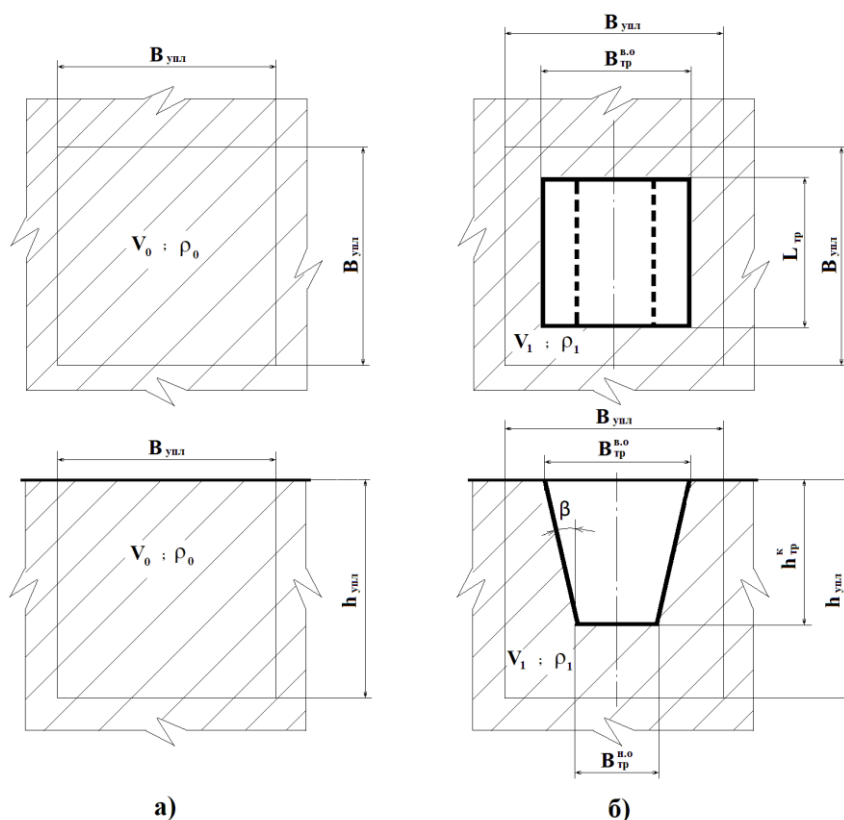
Расчетная схема формирования в грунте канала водоотведения в слабых грунтах:
